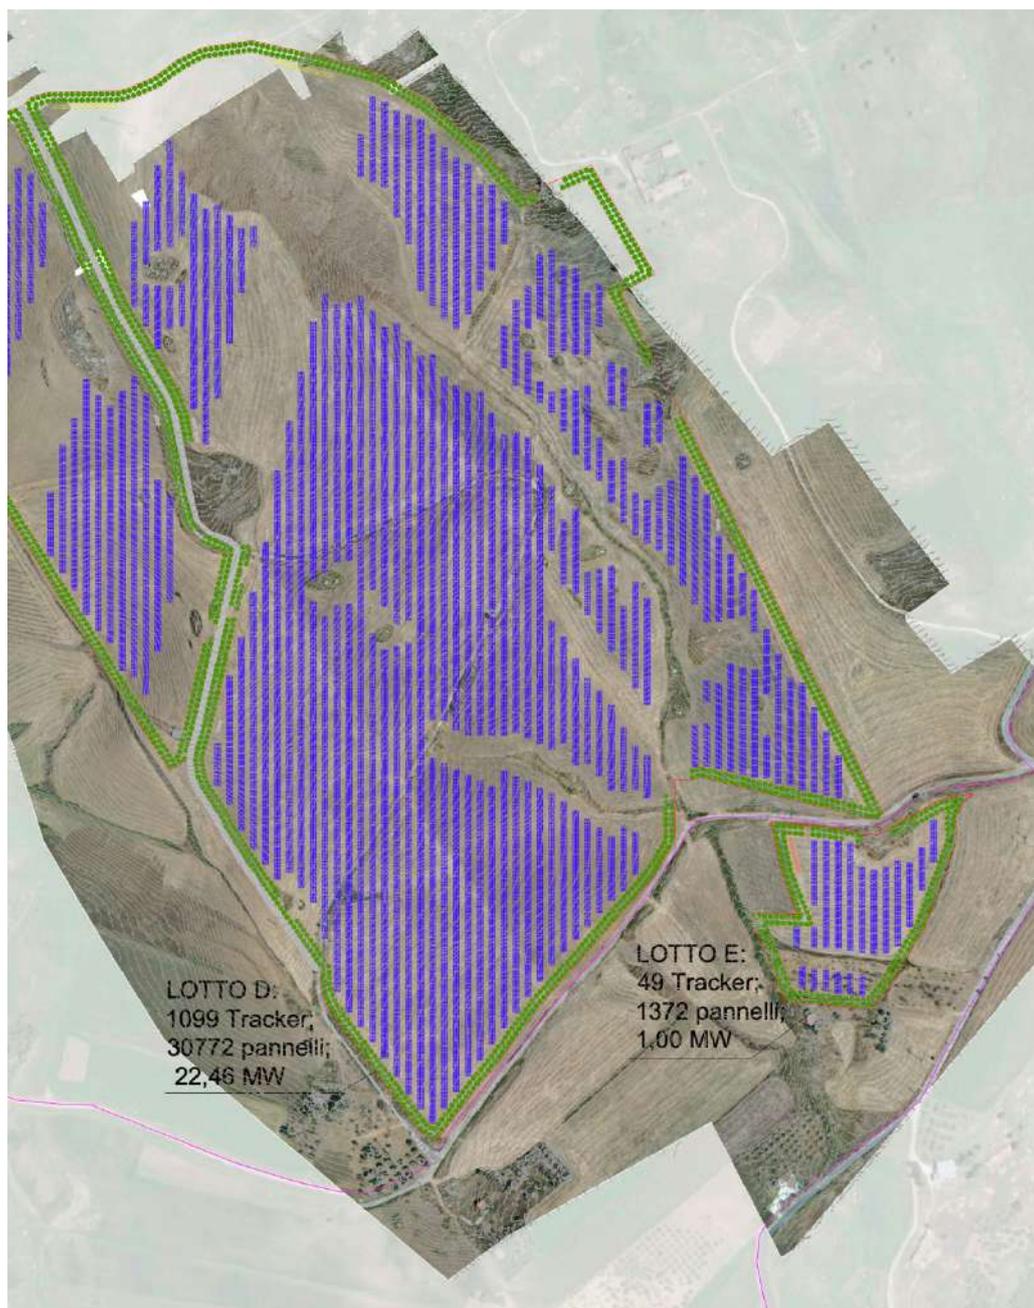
Particolare Layout di impianto area D ed E su stralcio rilievo
